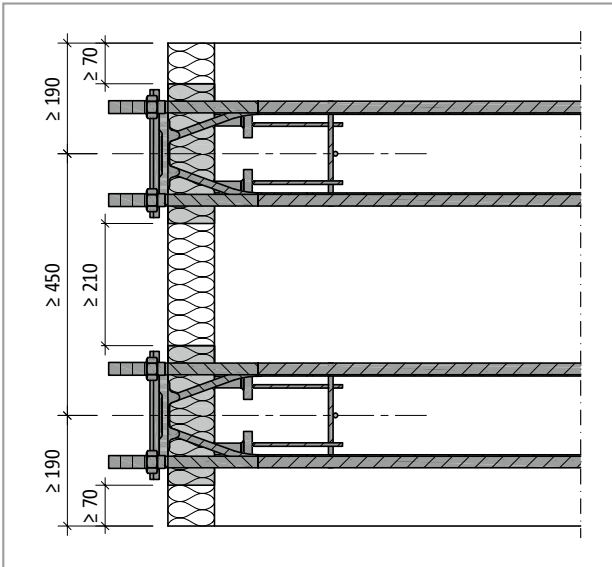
Schöck Isokorb® T type K-IQ : entraxe
